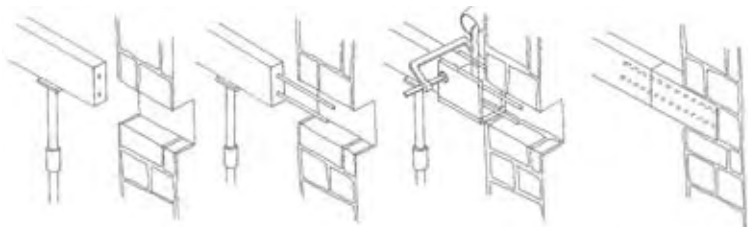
Reparação da zona de apoio de uma viga com argamassa epoxídica e armaduras.
